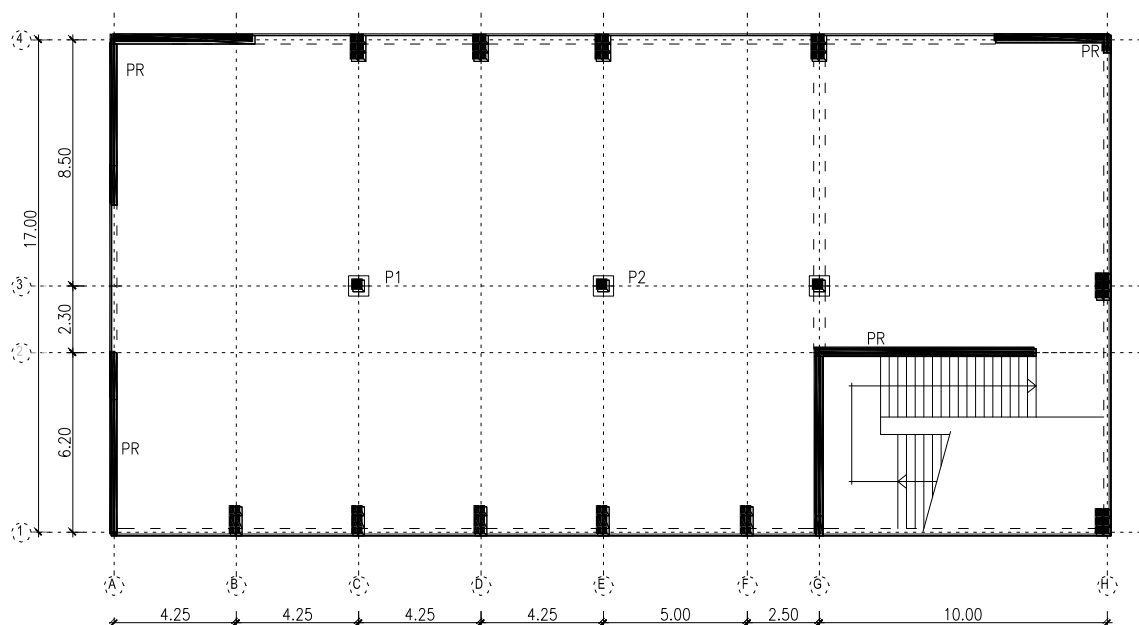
Planta da laje do caso de estudo. (desenho sem escala e dimensões em m)
